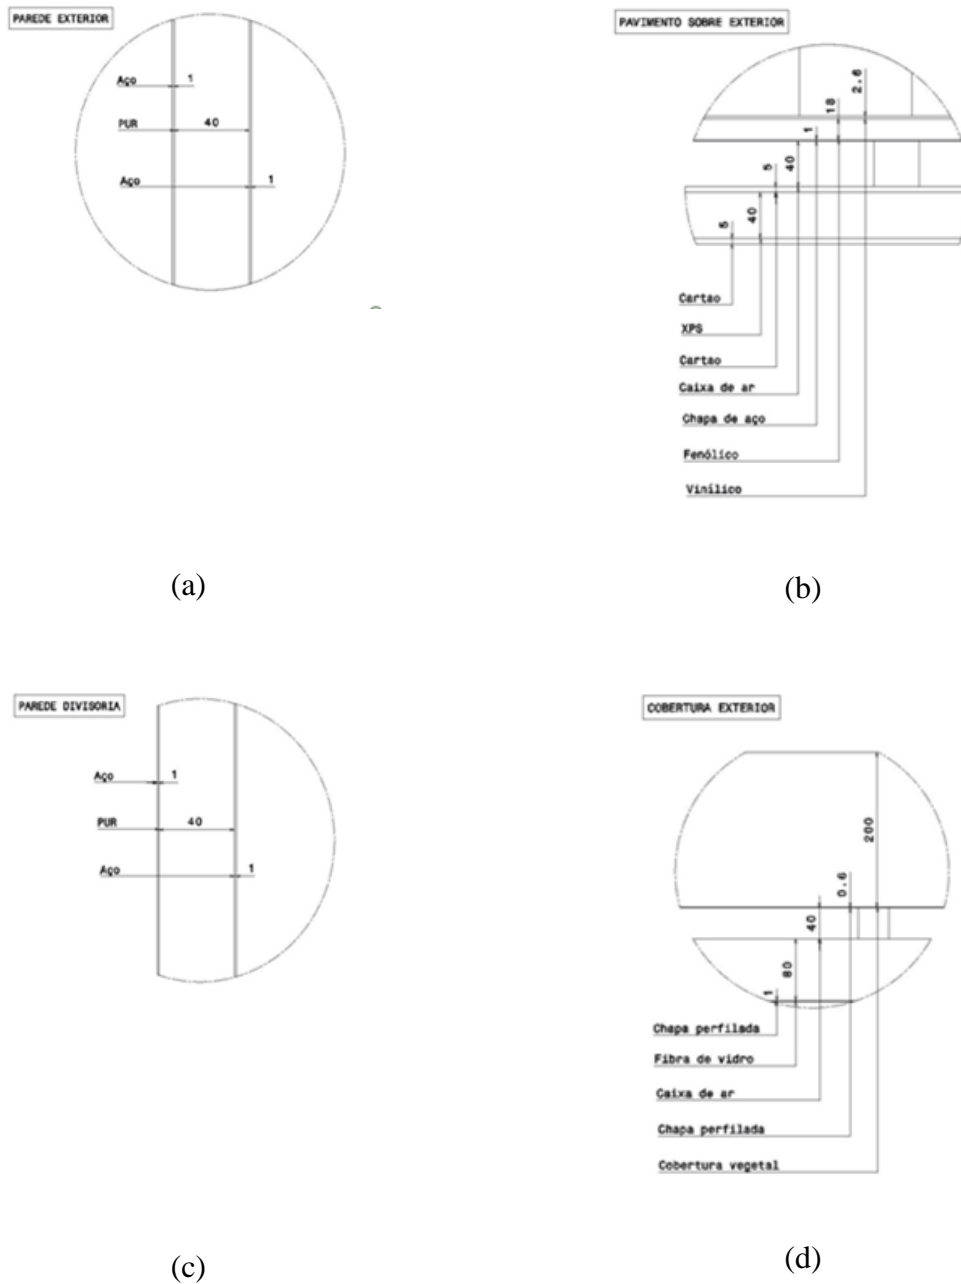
Tipo de materiais nos elementos construtivos em (a) Parede exterior (b) Pavimento sobre o exterior (c) parede divisória (d) Cobertura exterior
